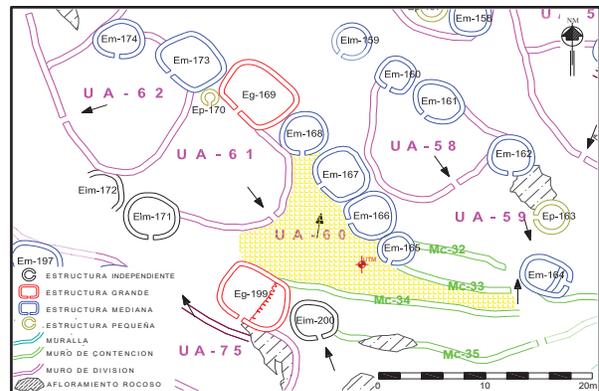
Vista en planta de la unidad arquitectónica UA-60, dispuesta de manera lineal en Llaqtapata. Fuente: Propia.
